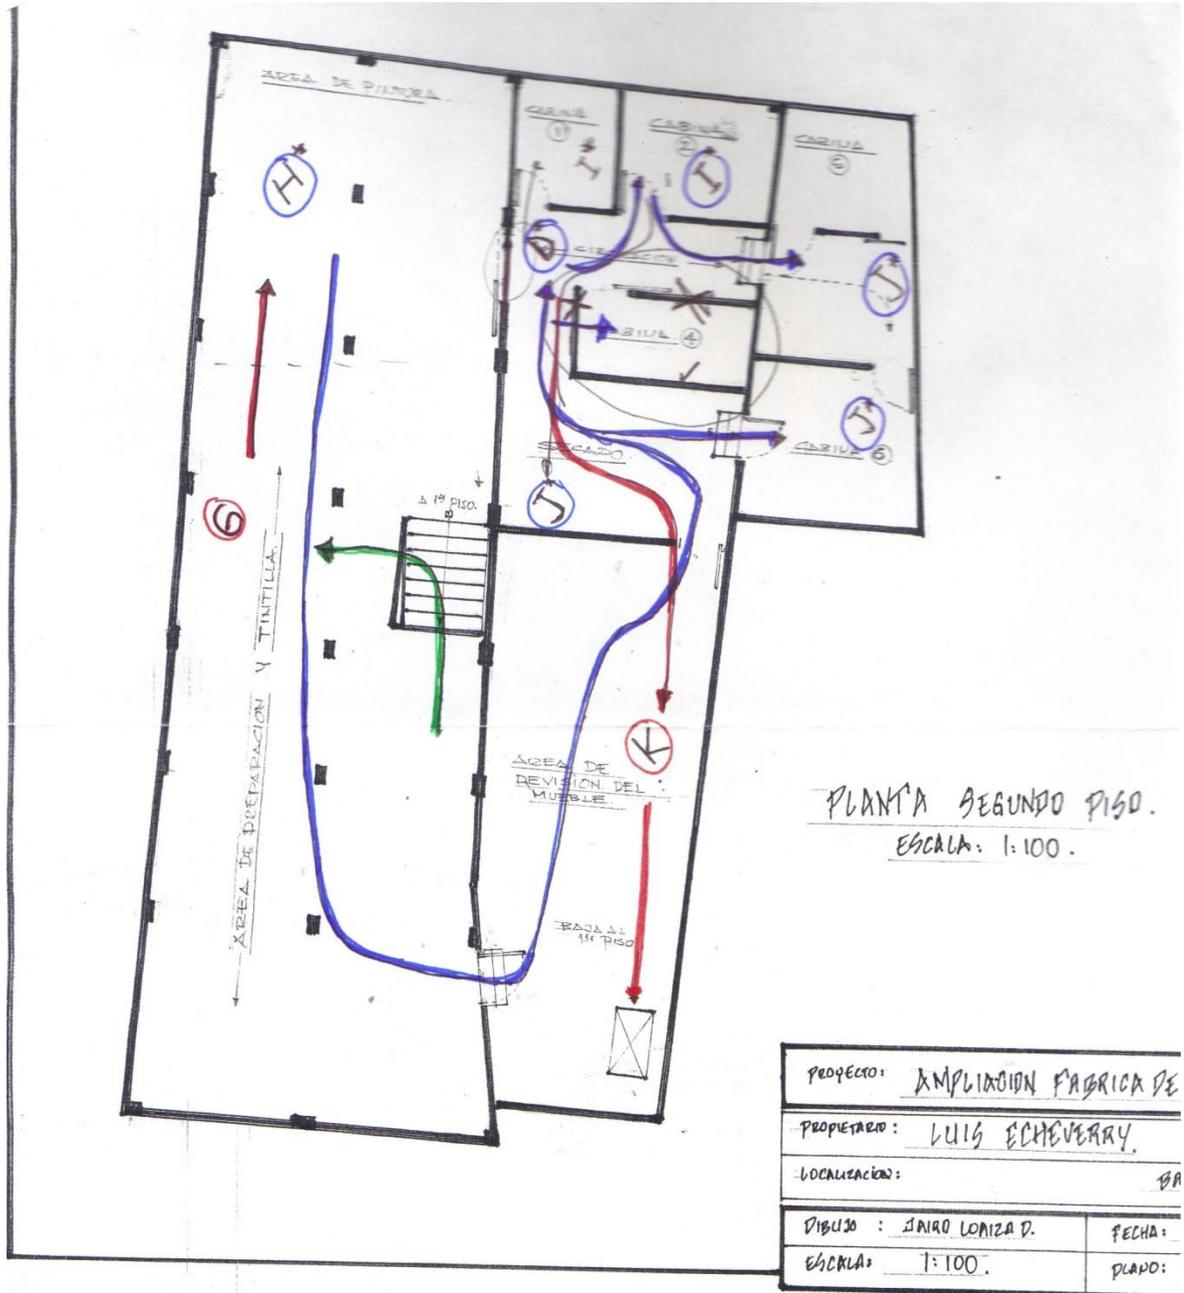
Ubicación de las zonas de trabajo en la primera planta
